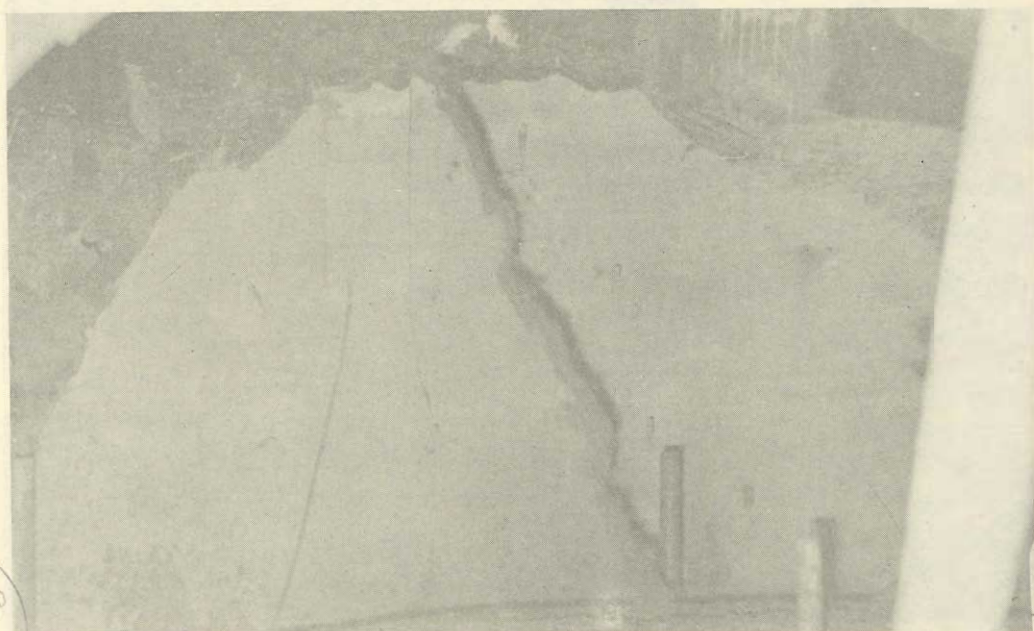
Preenchimento de um túnel com concreto de elevada trabalhabilidade, (Slump 23 cm), com utilização de agente expansor (ver Capítulo 16)
